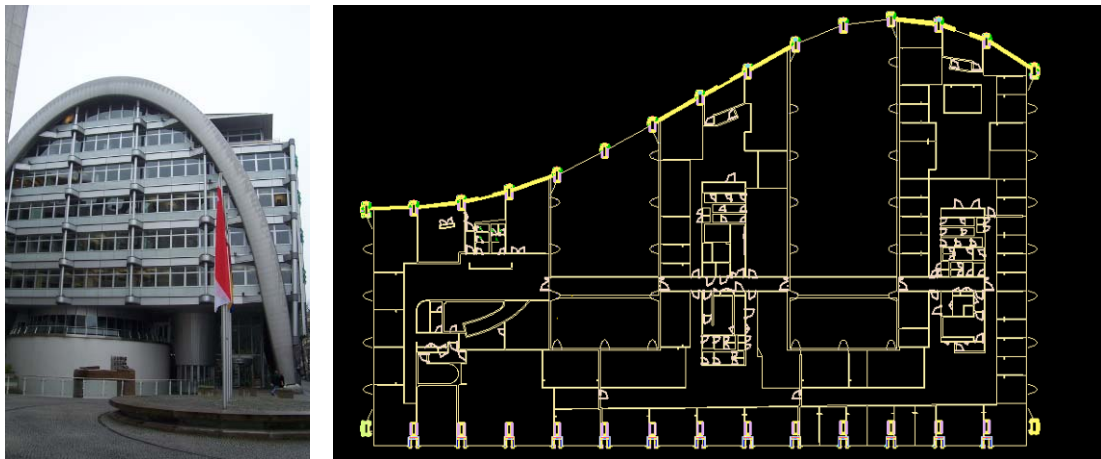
Ansicht des Ludwig Erhard Hauses in Berlin und Grundriß 2.OG
